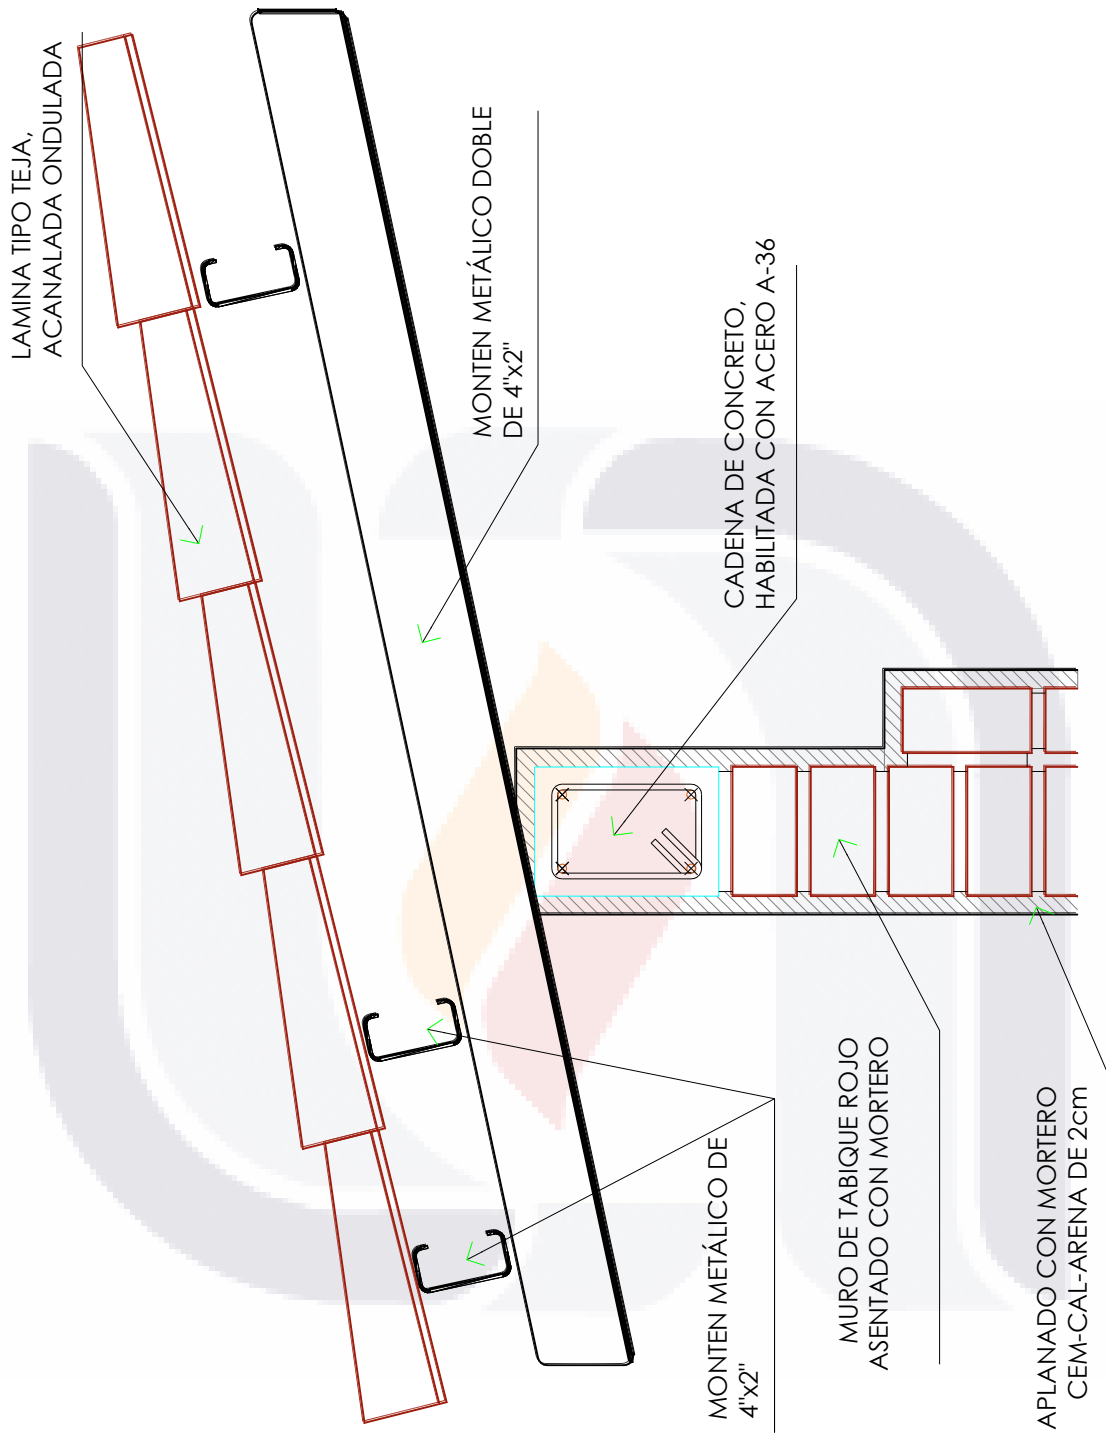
Detalle arquitectónico de la estructura de la cubierta metálica de terraza y habitación central.
